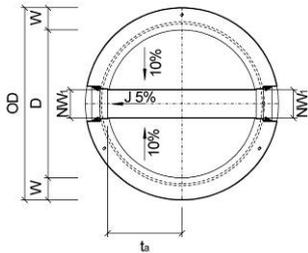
Grundriss CRENO Normschachtboden Typ 1
